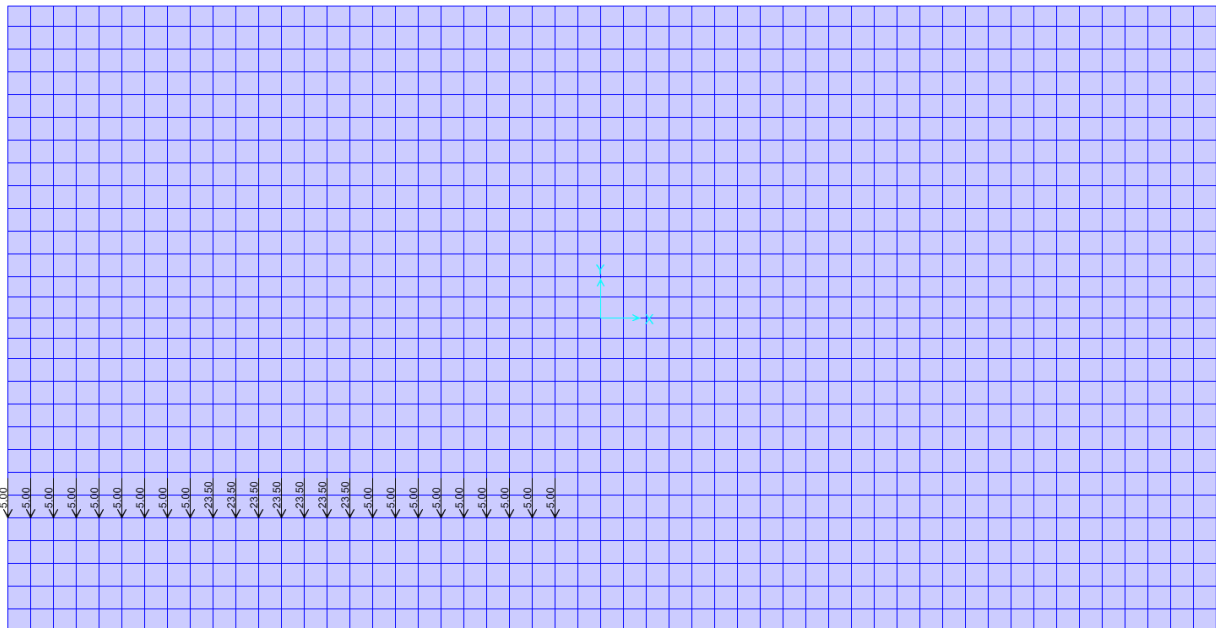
Q4,4 – Serpeggio (nell'immagine – pianta della soletta superiore)
